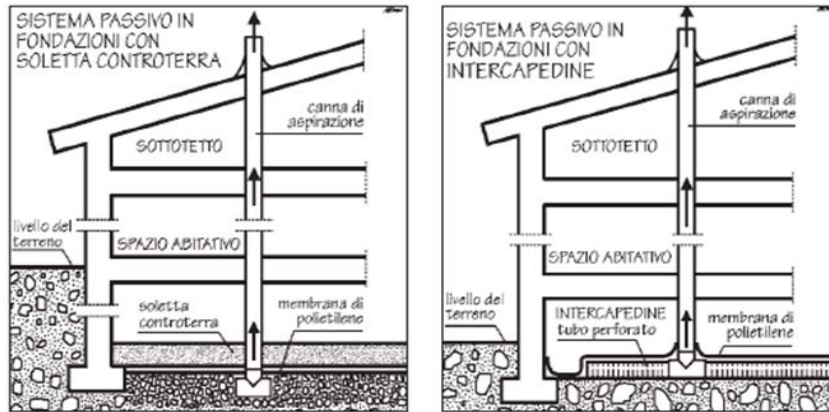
Sistema passivo in fondazioni con soletta controterra; Fig 2 – Sistema passivo in fondazione con intercapedine.
